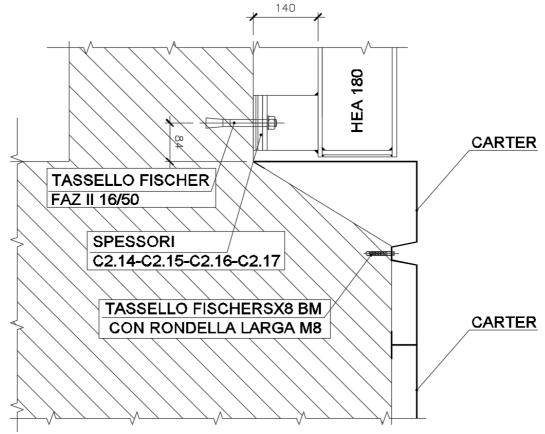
Dettaglio del collegamento HEA180 basso della barriera lato ferrovia
